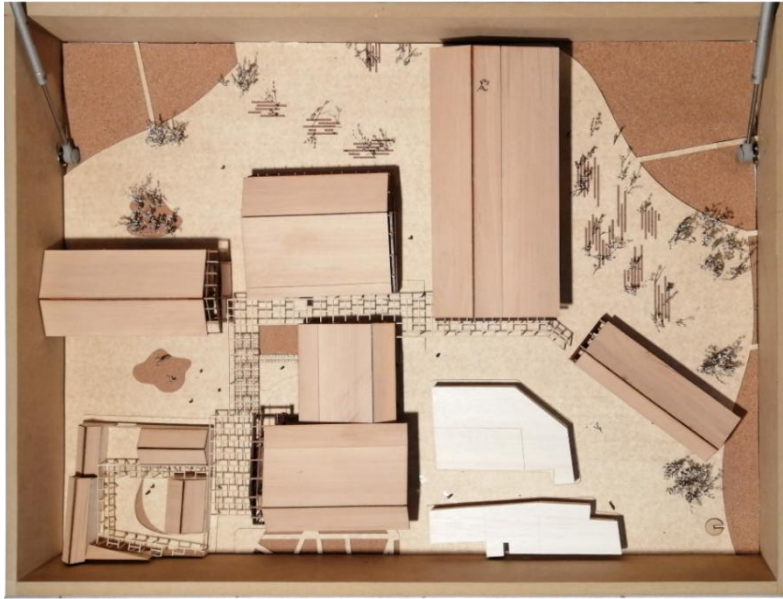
Maqueta Proyectual Esc 1/125 Fuente: Propia
